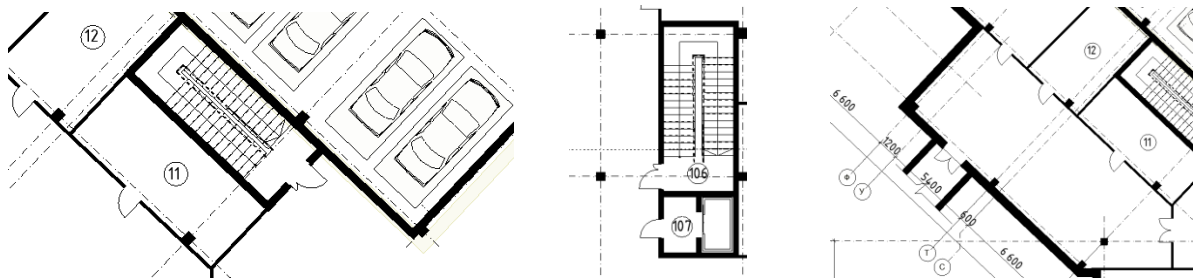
Входи до укриття на рівні -1 поверху із будівлі та облаштування виходу з укриття
